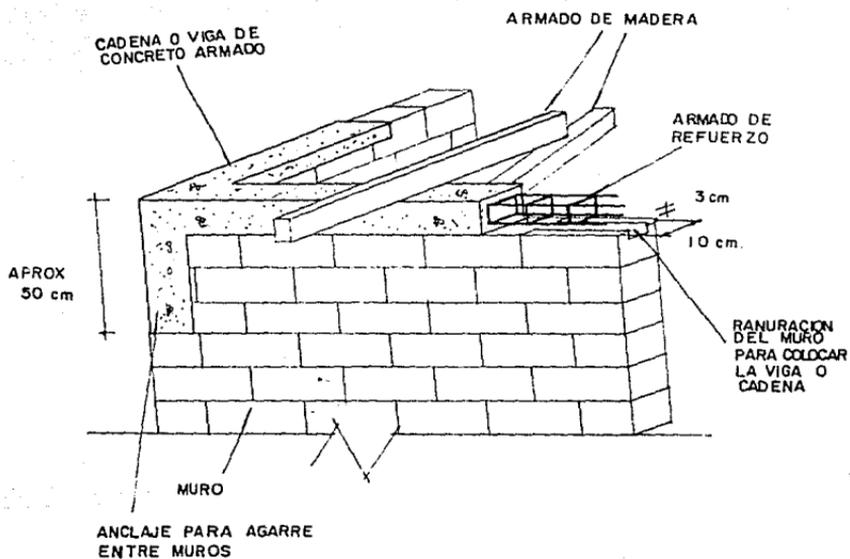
7 . 2 FIG. DONDE SE ILLUSTR A EL CONFINAMIENTO DE UN MURO DE MANPOSTERÍA CON CADENA DE CONCRETO PERIMETRAL
